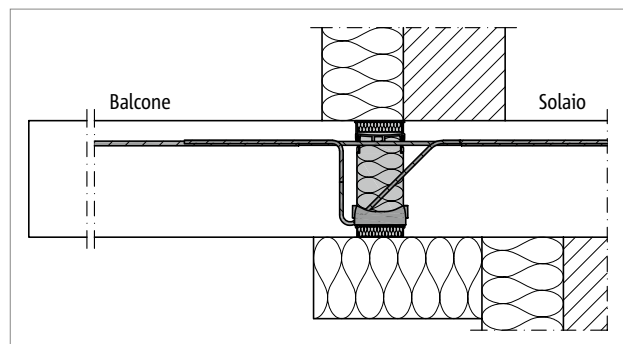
Schöck Isokorb® T tipo K: raccordo con appoggio solaio indiretto e sistema di isolamento a cappotto
